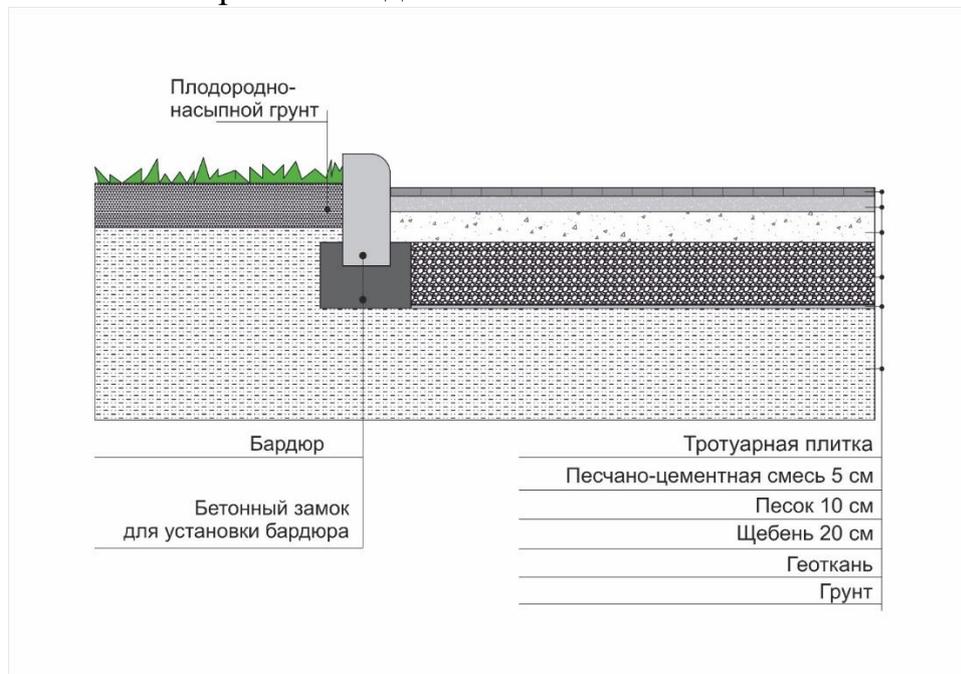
Узел примыкания покрытия из бетонной плитки к перебрику (схема автора)
